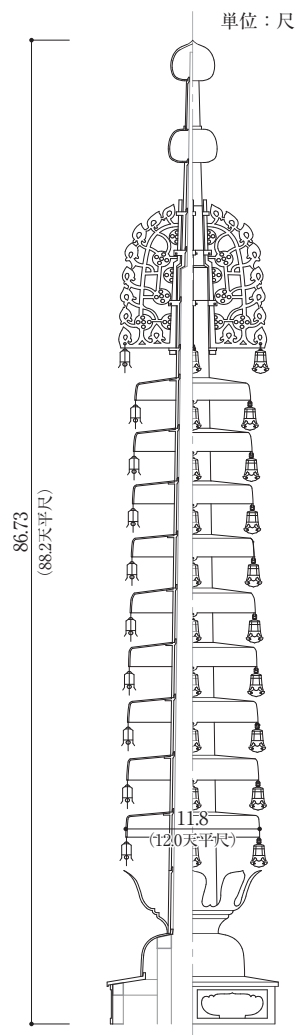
鎌倉塔相輪 立断面図
